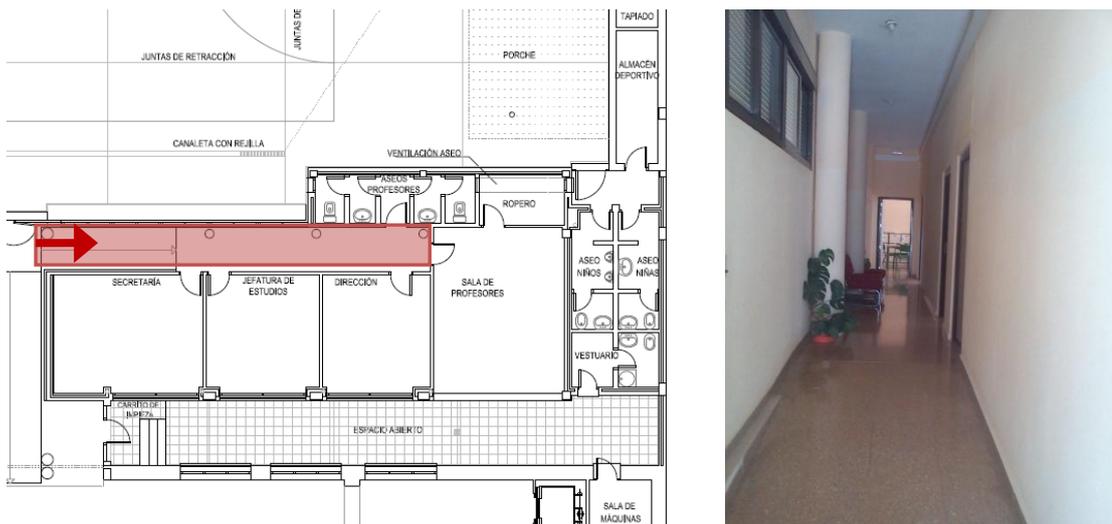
Situación y vista del pasillo Oeste-B de P.B. (foto autor)
